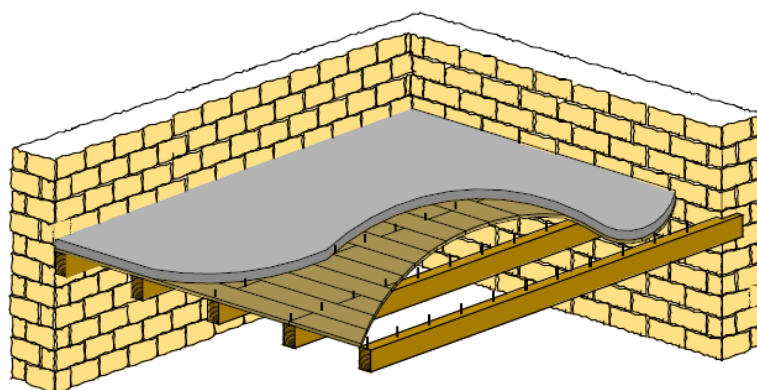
Esboço de uma estrutura mista de madeira-concreto mantendo o soalho
